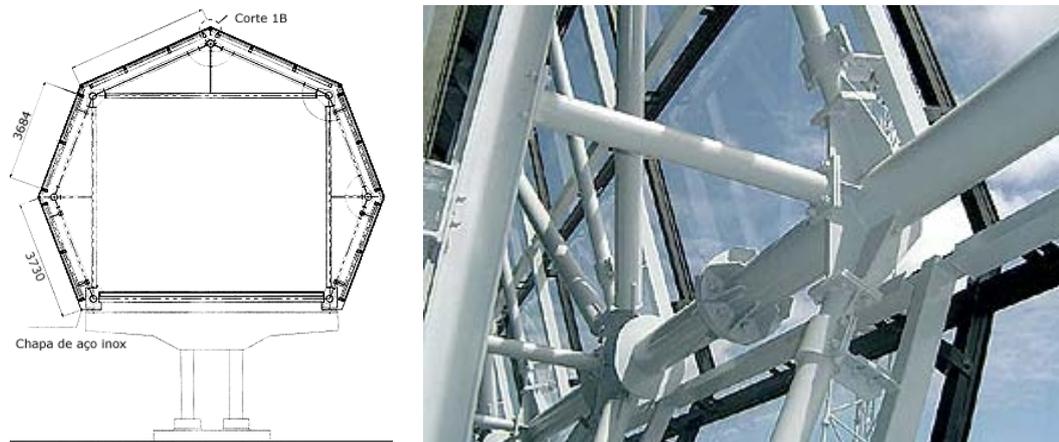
e 105 – Fachadas com panos de vidro inclinados
